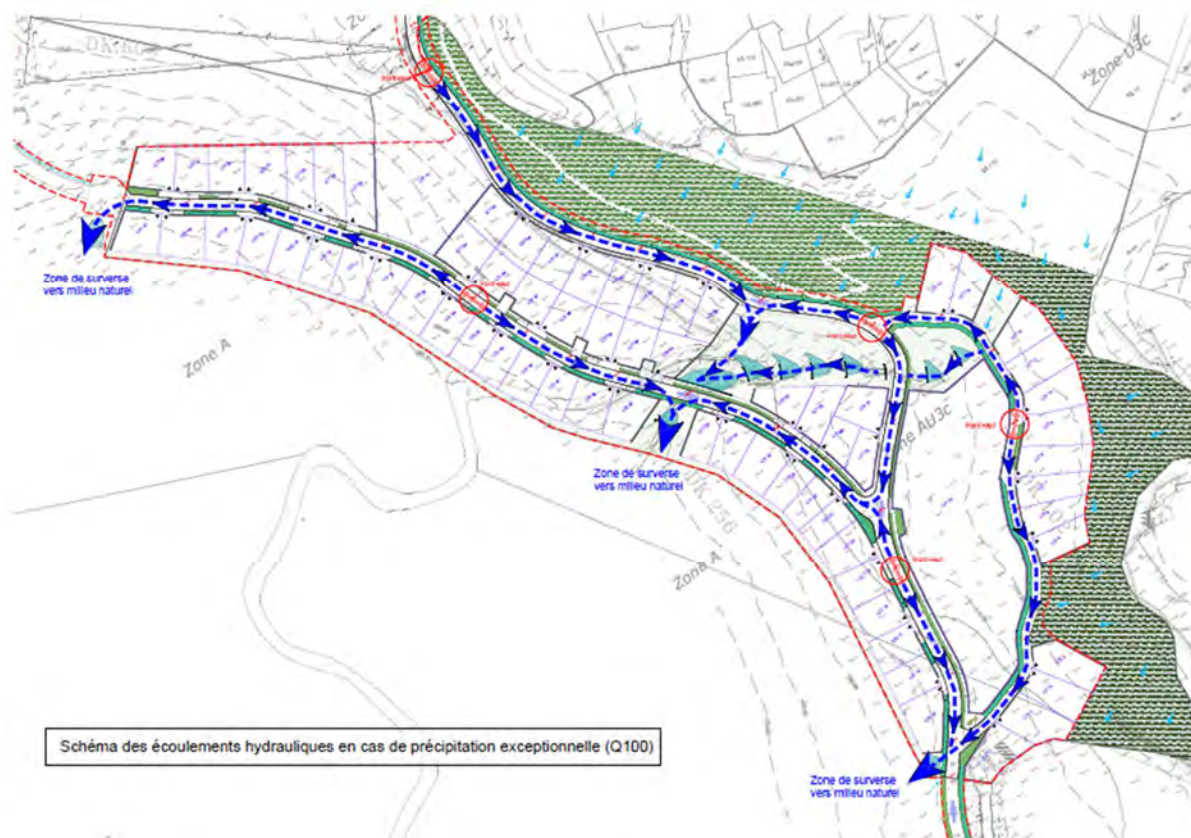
Plan de gestion des eaux pluviales en Q100 (Source: Atelier LD)
